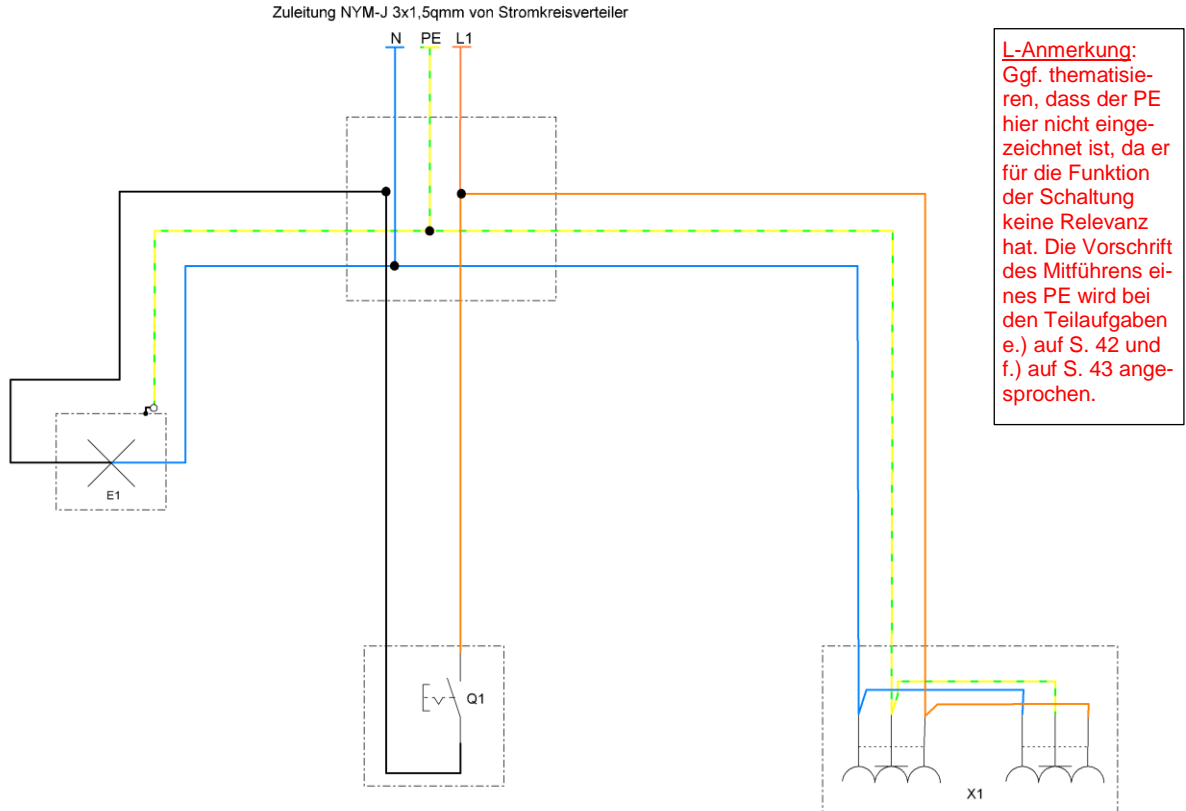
Stromlaufplan des Badezimmers in zusammenhängender Darstellung
